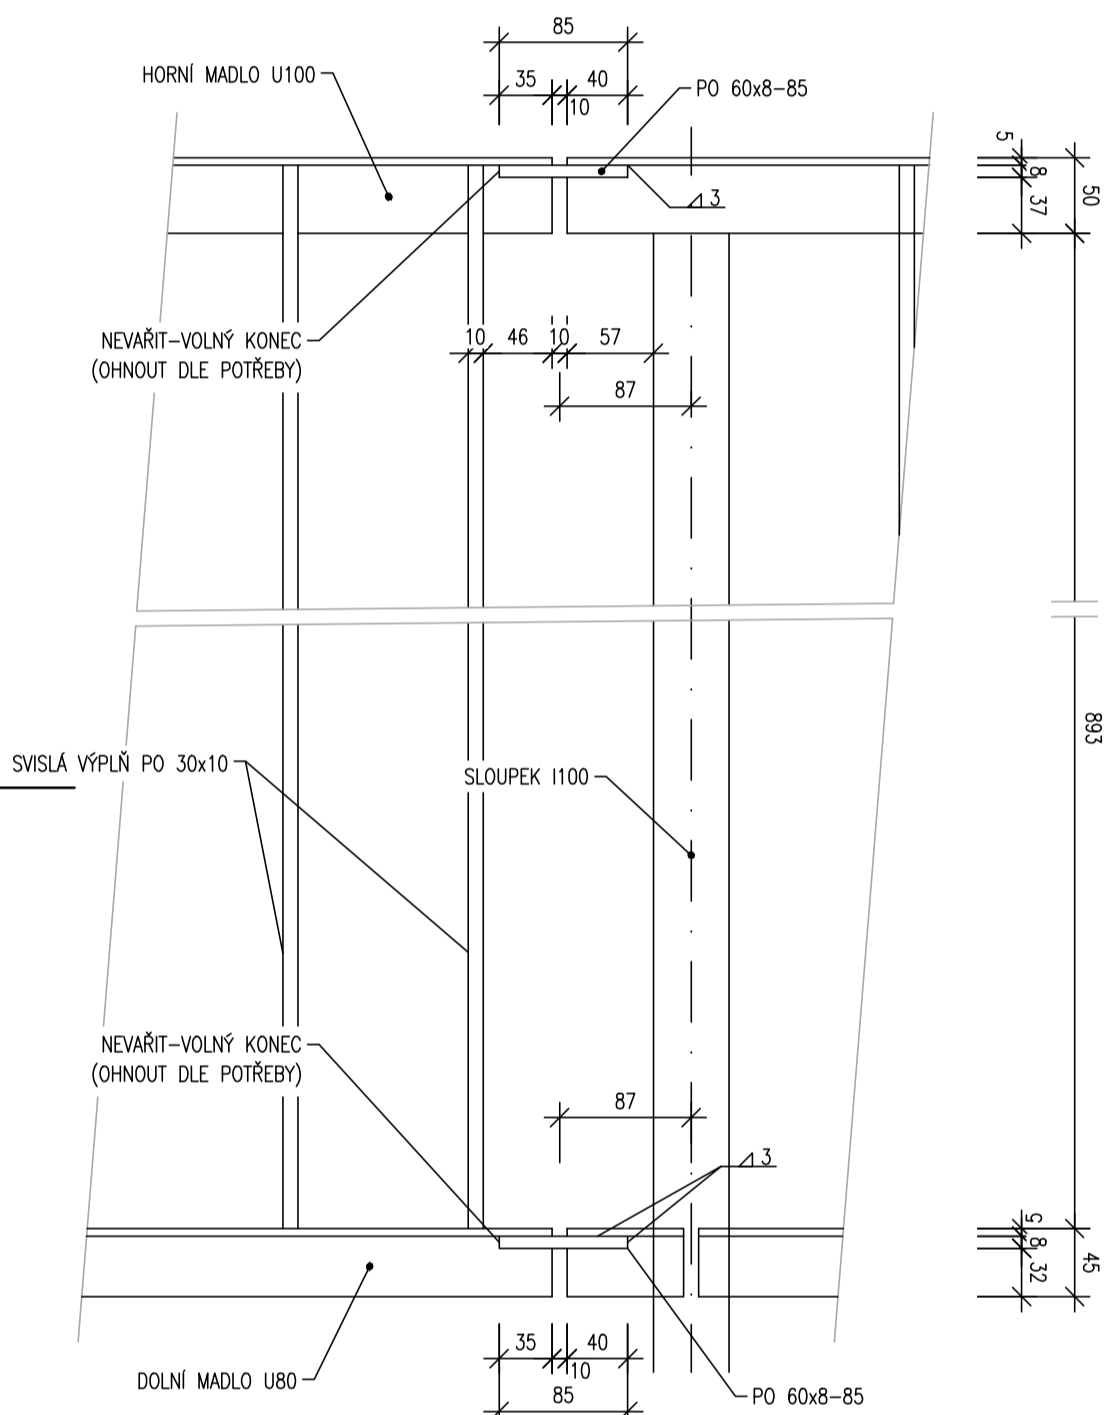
DETAIL ZÁBRADLÍ – POLE 2,0 m 1:20
